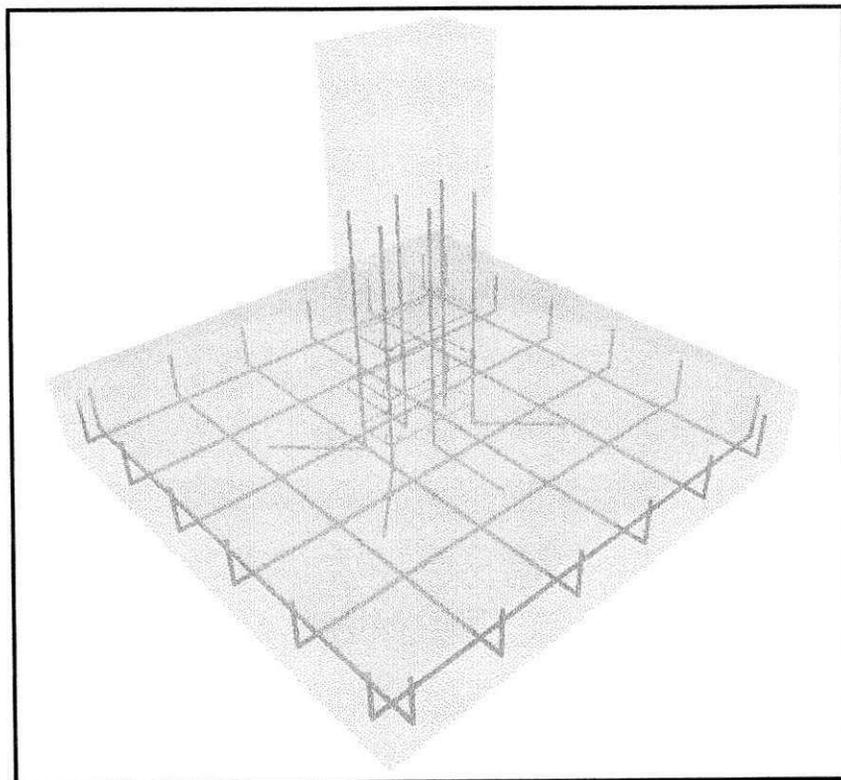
Detalhamento da sapata do pilar P1 com vista em 3D
